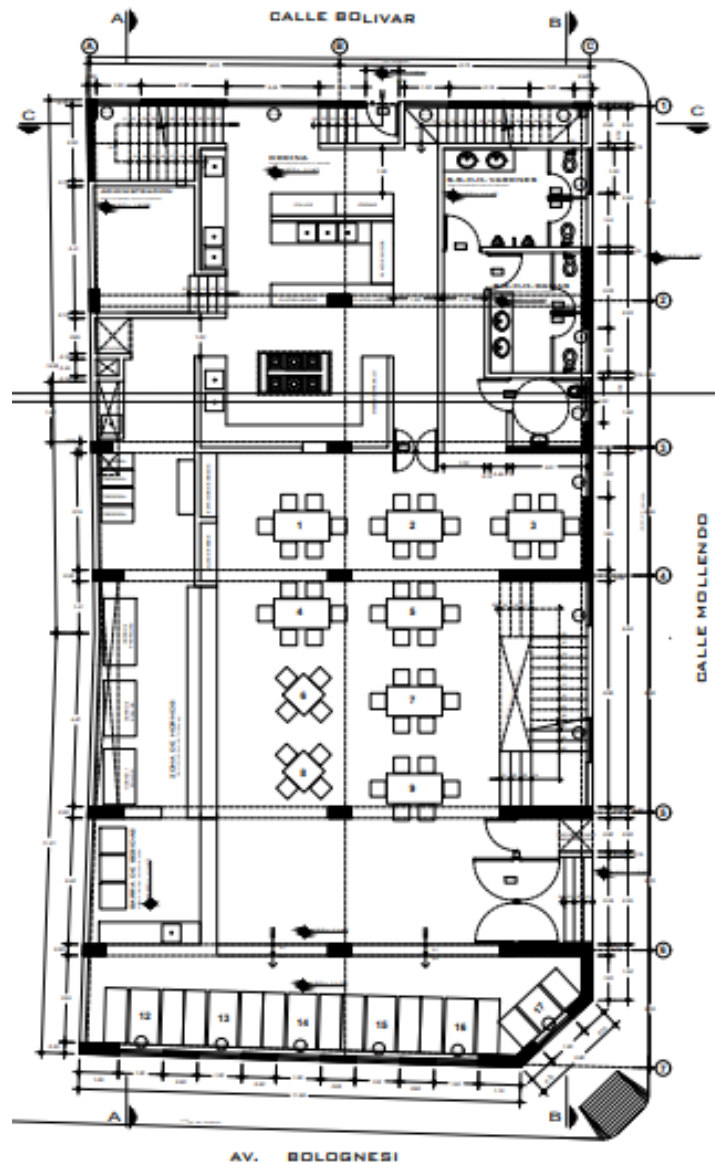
Plano en planta del edificio; Fuente: (Elaboración propia).
